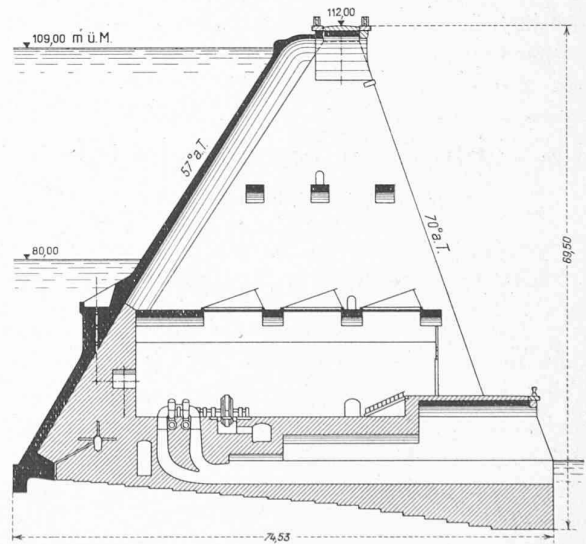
Coupe à travers le barrage du Tirso, en Sardaigne. — 1 : 1000.
